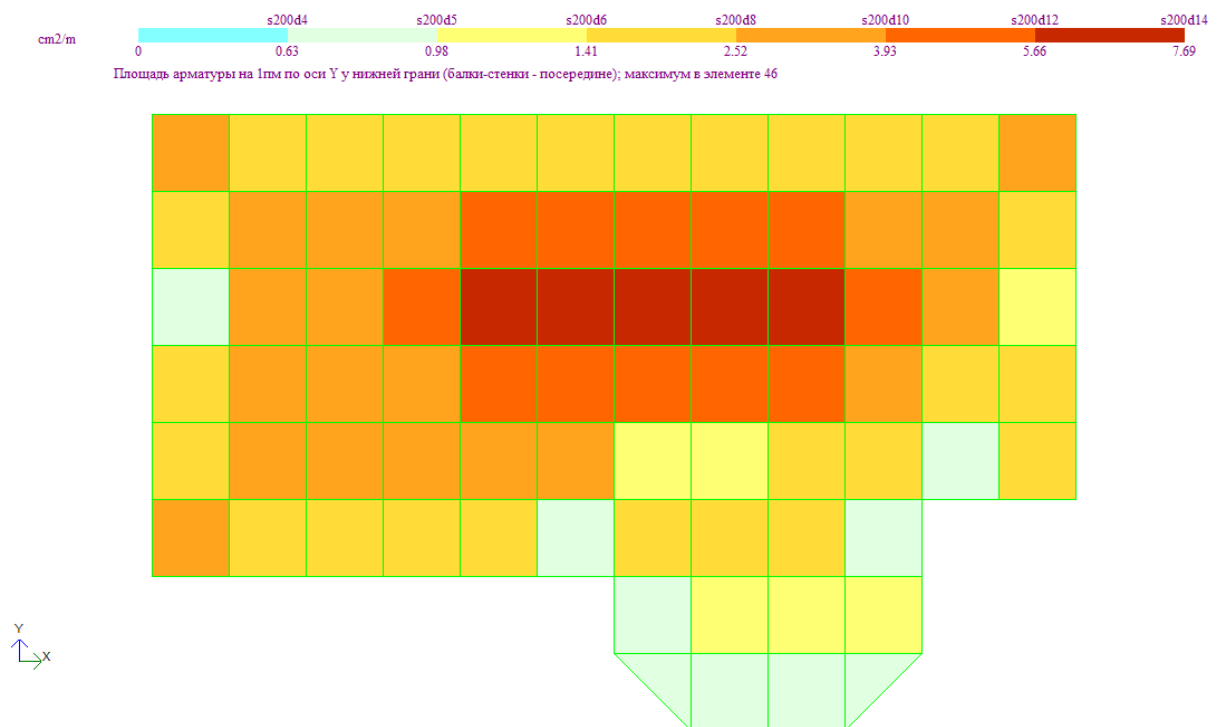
Площадь арматуры на 1 пм для монолитного участка плиты перекрытия по оси Y у нижней грани
